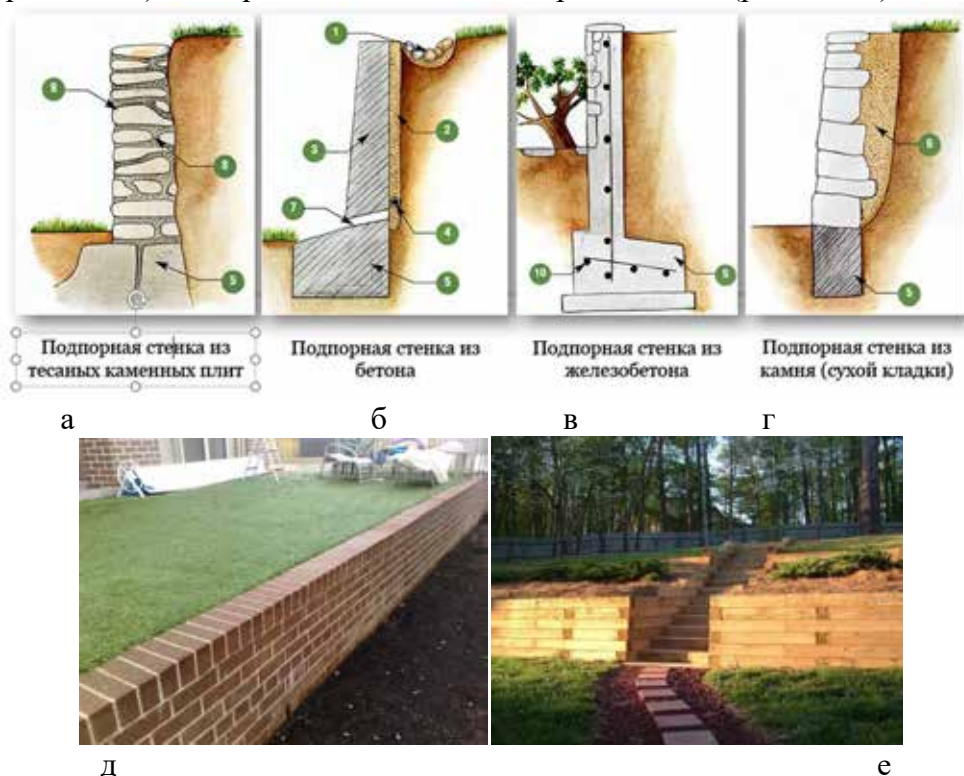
Классические примеры подпорных стенок: а - подпорная стенка из тесаных каменных плит; б - подпорная стенка из бетона; в - подпорная стенка из железобетона; г - подпорная стенка из камня (сухой кладки); д - подпорная стенка из керамического кирпича; е - подпорная стенка из дерева твердых пород: 1.Открытый лоток; 2.Дренарующий слой из песка; 3.Тело подпорной стенки; 4.Дренажная труба; 5.Фундамент; 6.Щебень песчано-гравийная смесь; 7. Дренажное отверстие; 8. Каменные плиты; 9.Смесь для скрепления плит; 10. Арматура.
